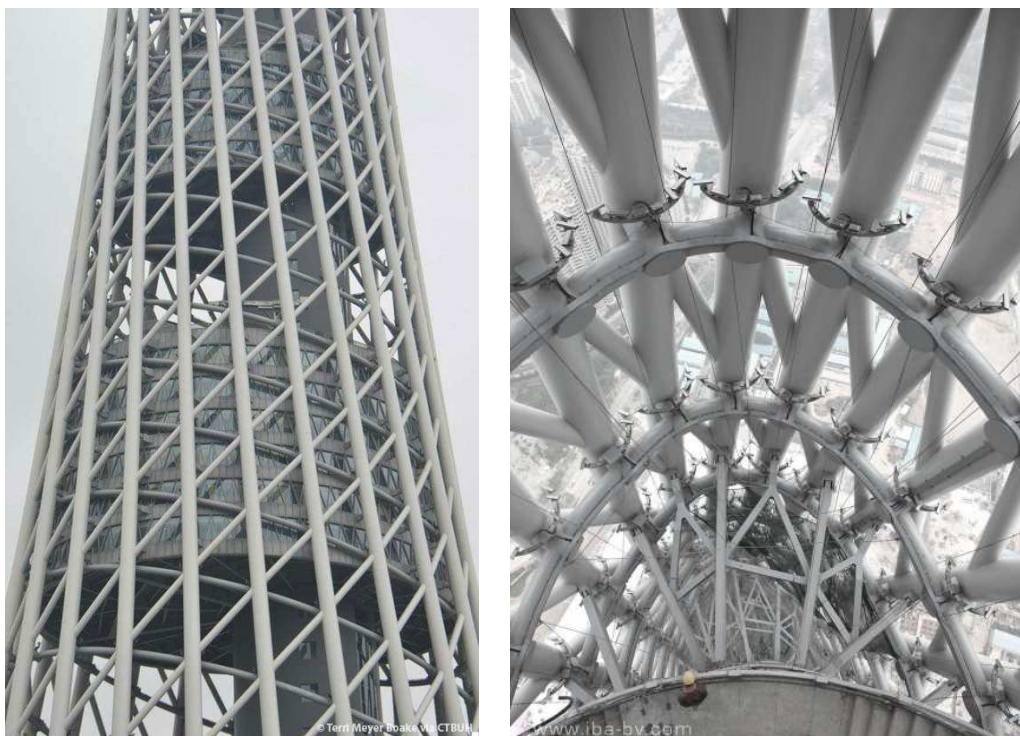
a i b Wieża Canton Tower w Chinach
